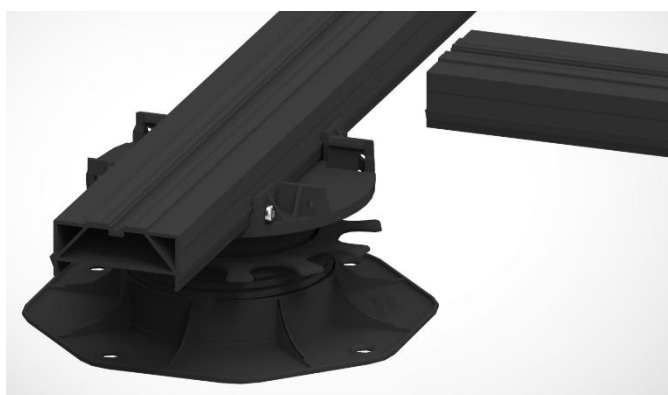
Die Aluminiumunterkonstruktion wird auf das Terrassenlager so weit aufgedrückt, bis das Terrassenlager eingerastet ist. Danach sollten alle Terrassenlager mit je 1 Bohrschraube 3,9 x 25 an der Unterkonstruktion fixiert werden.
